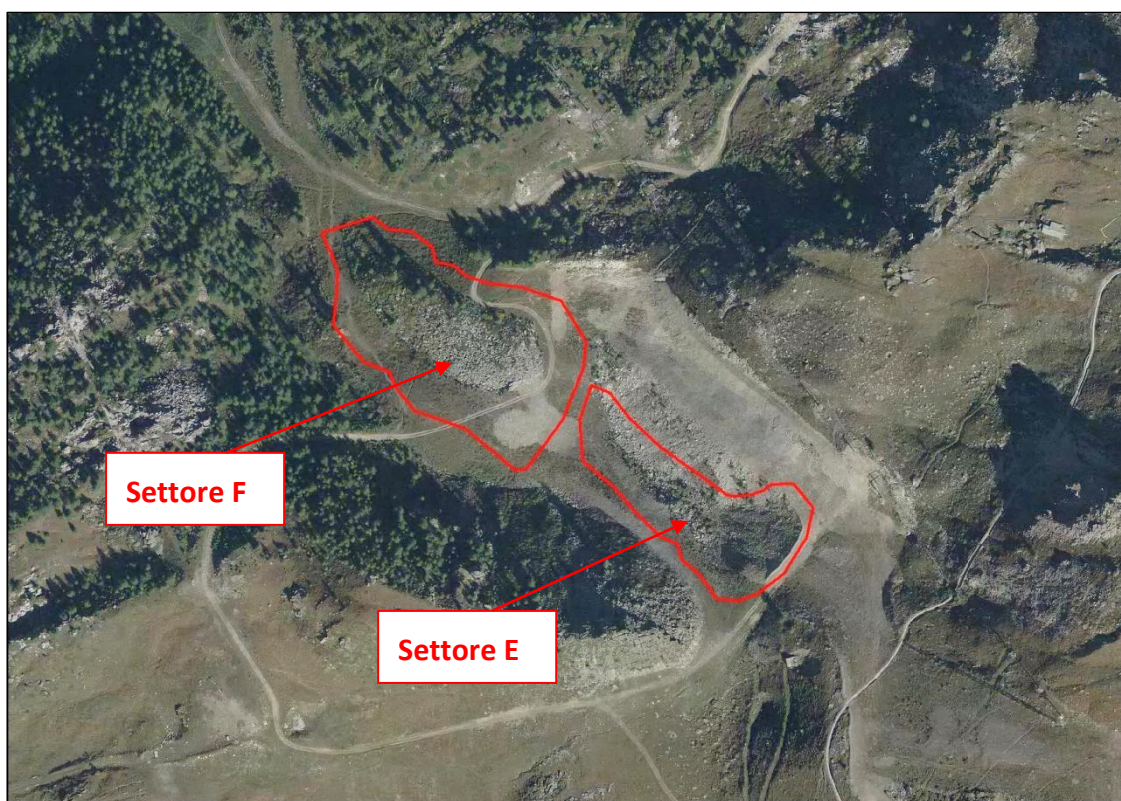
PLANIMETRIA DEGLI INTERVENTI SULLA PISTA N.22 SU BASE ORTOFOTO CON LOCALIZZAZIONE DEI SETTORI E E F (IN ROSSO)
